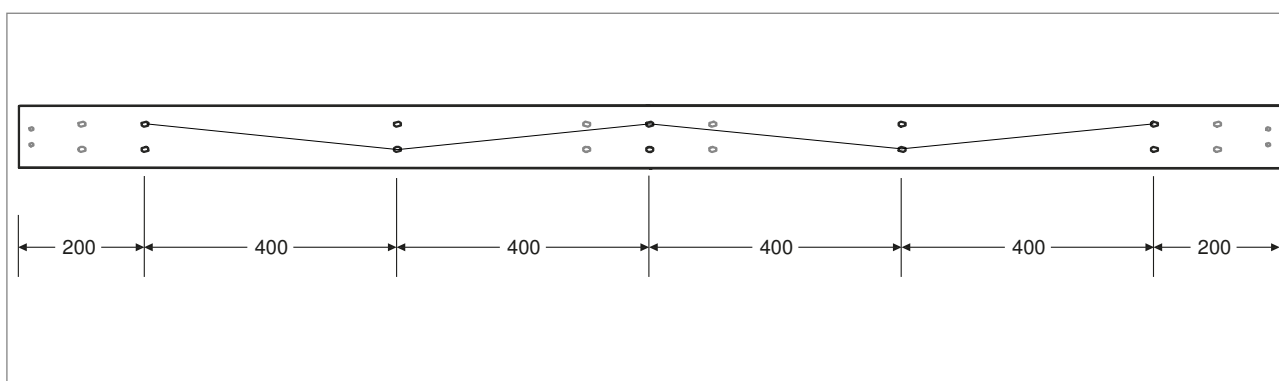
Configuration de perçage en cas de montage au mur et au plafond
